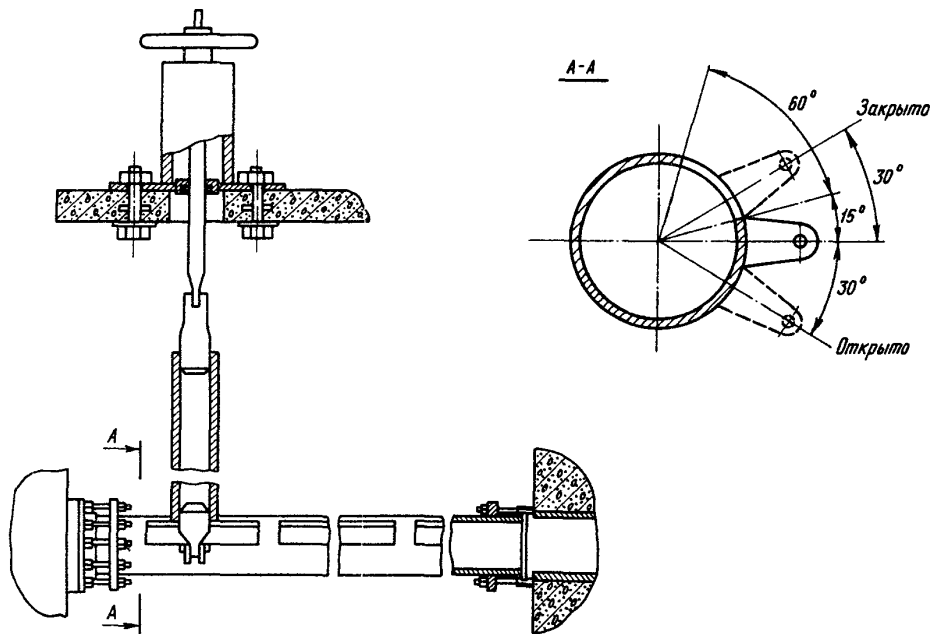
Неотсборная поворотная труба с ручным приводом и схема поворотного устройства (разрез А-А)
